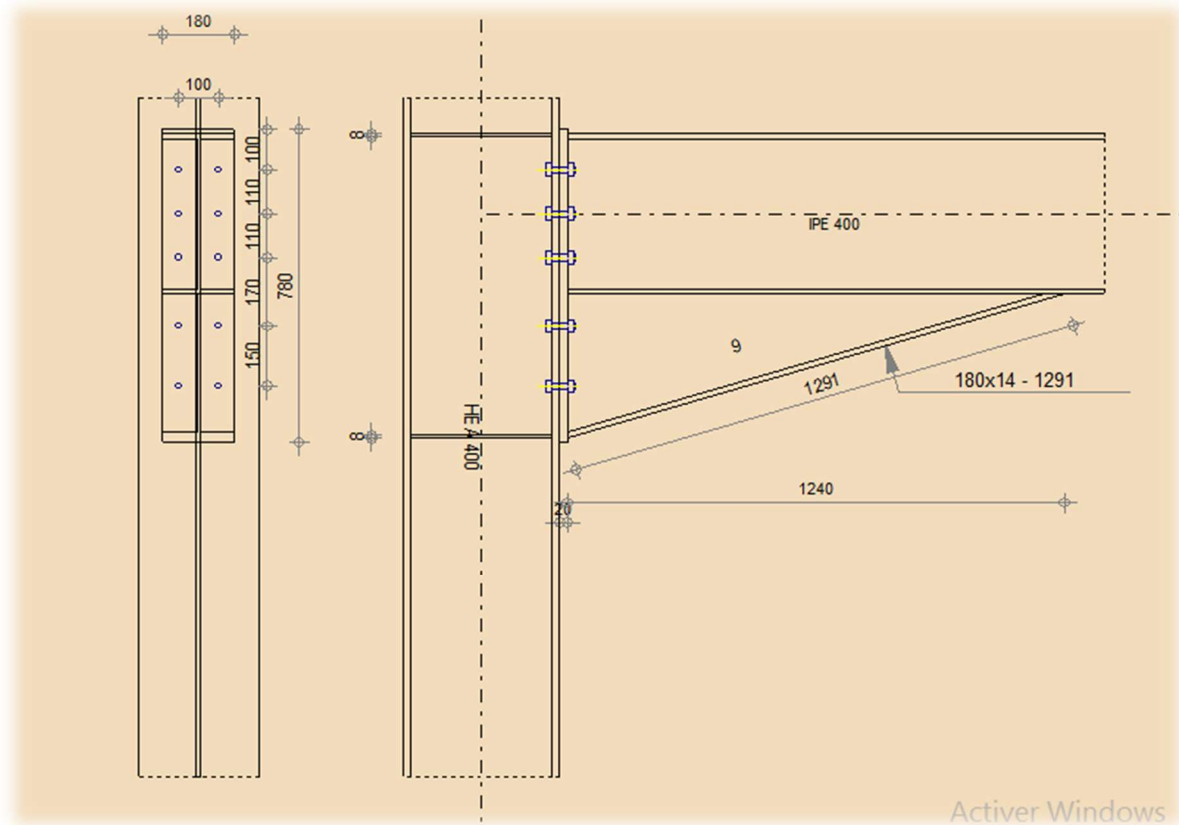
Détail d'assemblage poteau - poutre (HEA400-IPE400)
